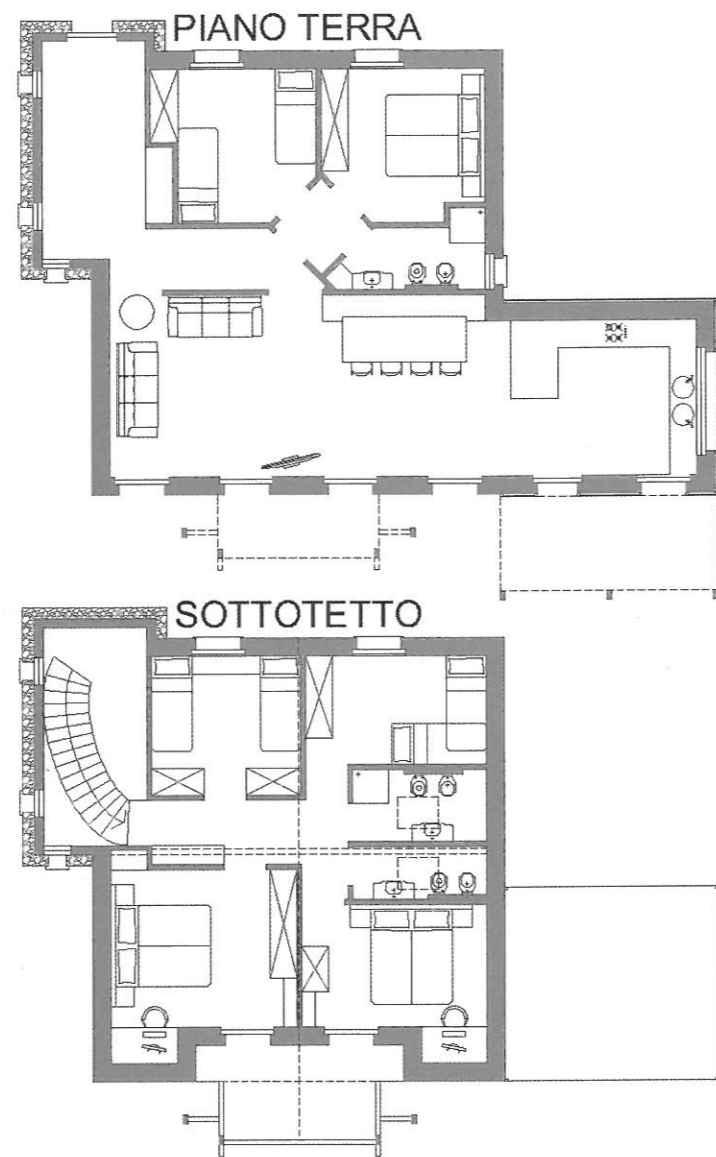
Planimetrie post operam del piano terra e del sottotetto
